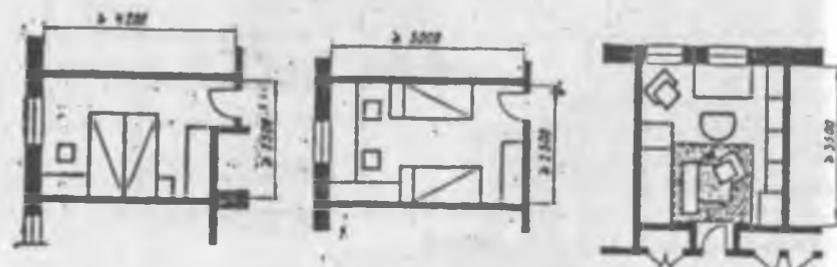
Варианты планировочных решений индивидуальных комнат при реконструкции жилых зданий
